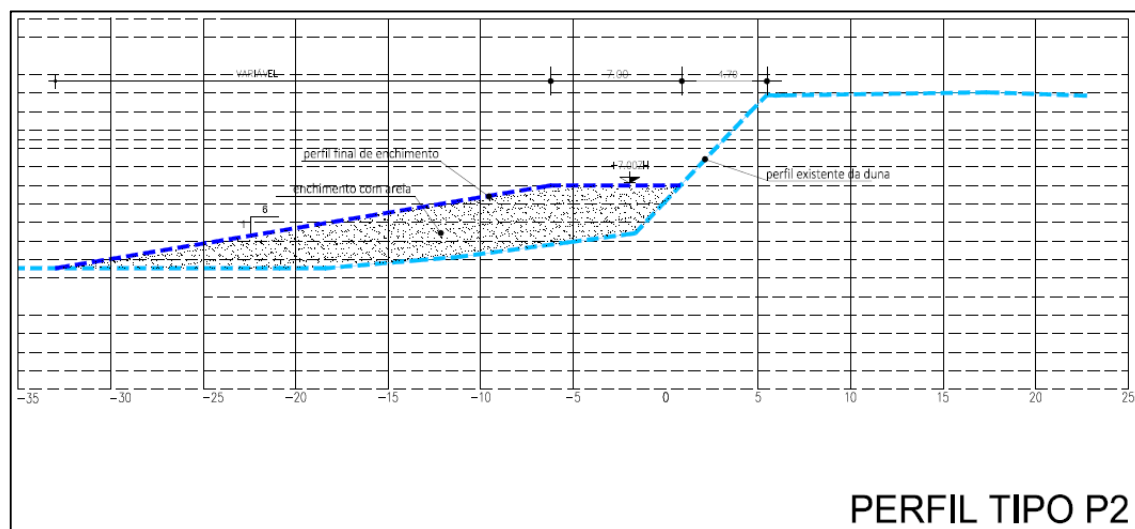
Troço Intermédio – Perfil tipo (fonte: APA, fevereiro de 2014)
